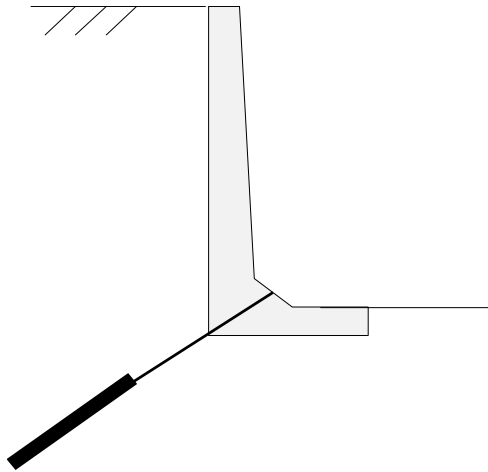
Muro de concreto armado (Foto GeoRio)
